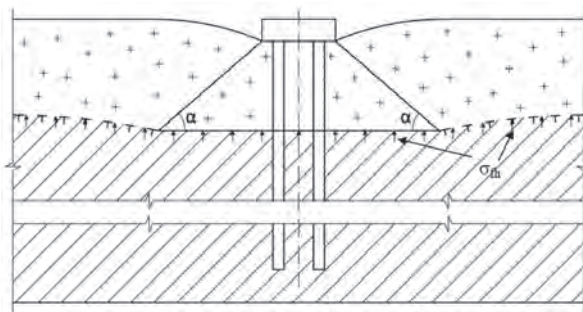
Расчетная схема расчета устойчивости фундамента на действие сил морозного пучения для свайного фундамента с ростверком в зоне промерзания
